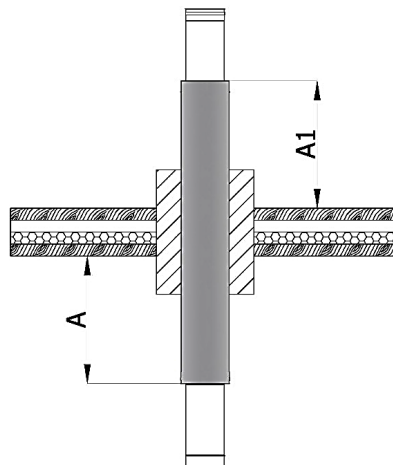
Attraversamento solaio non ventilato con passaggio a tetto
